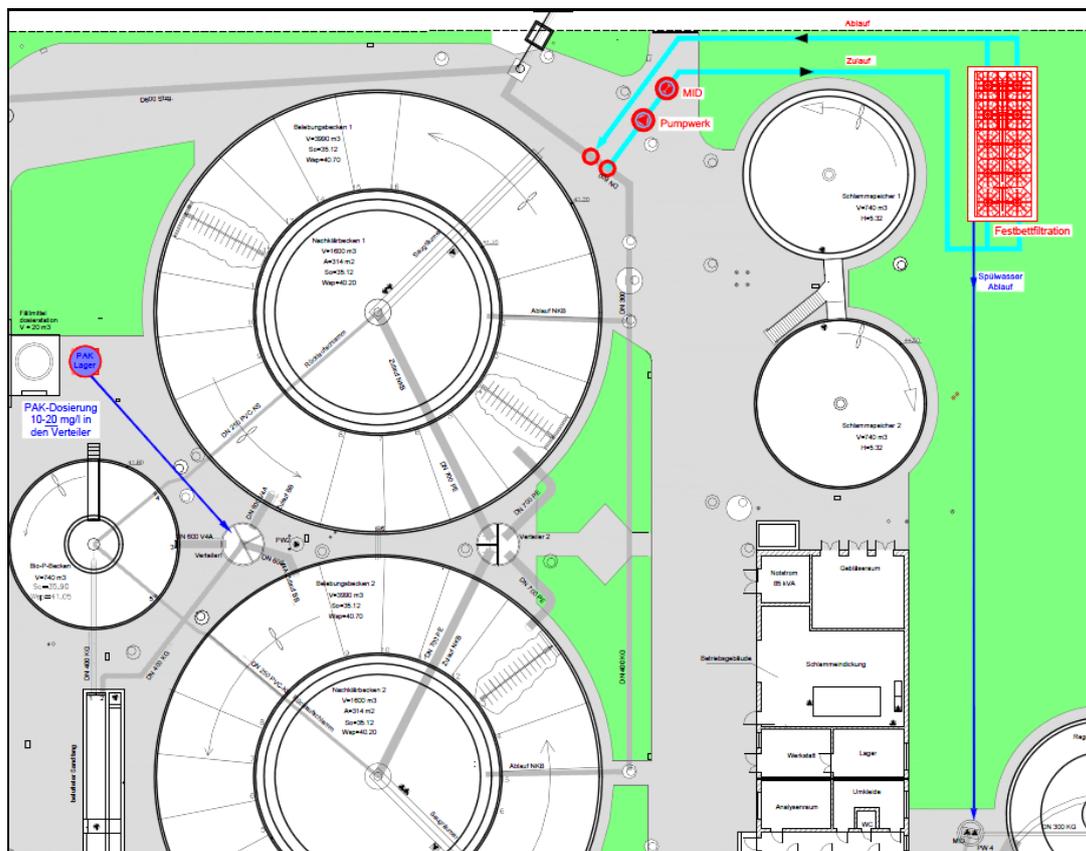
Lageplan KA Rahden - Variante 1.1 – PAK Dosierung in die Belebung, Dyna-Sand Filtration Ablauf Nachklärung
